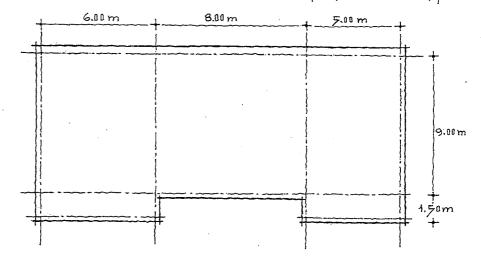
Superficie ocupado por el edificio. Planta.
